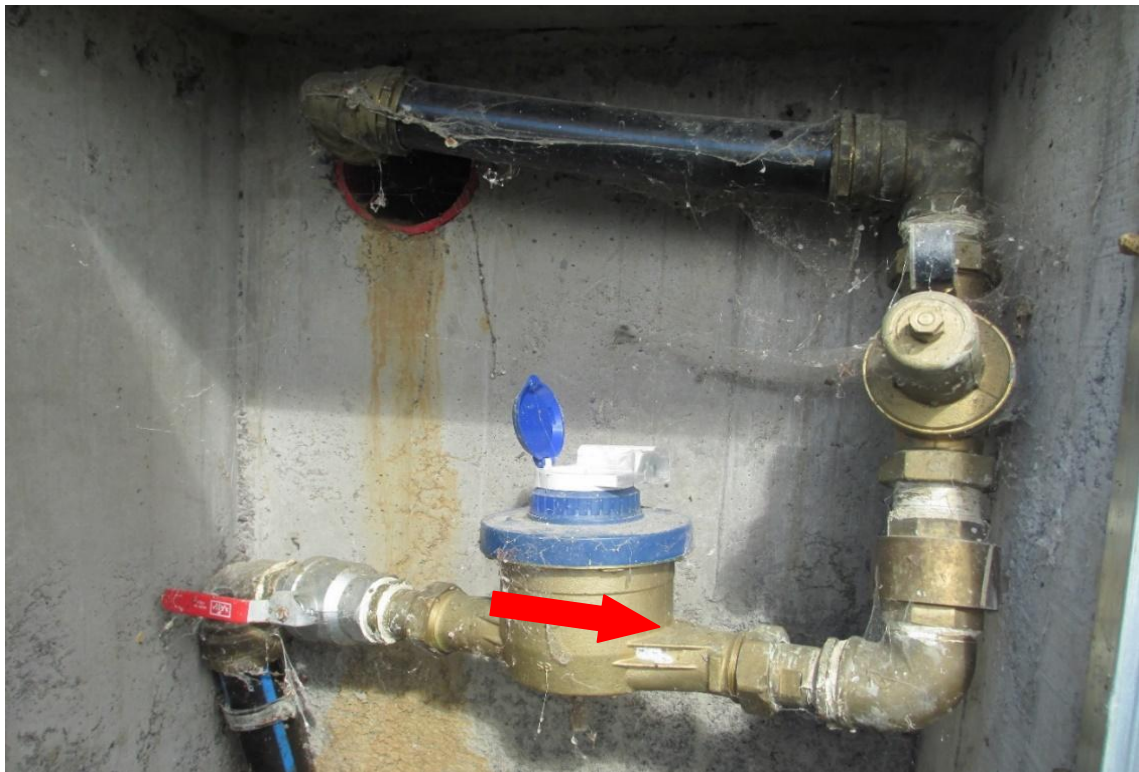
Foto de la instalación original del contador en E38 (Hotel), Z.
